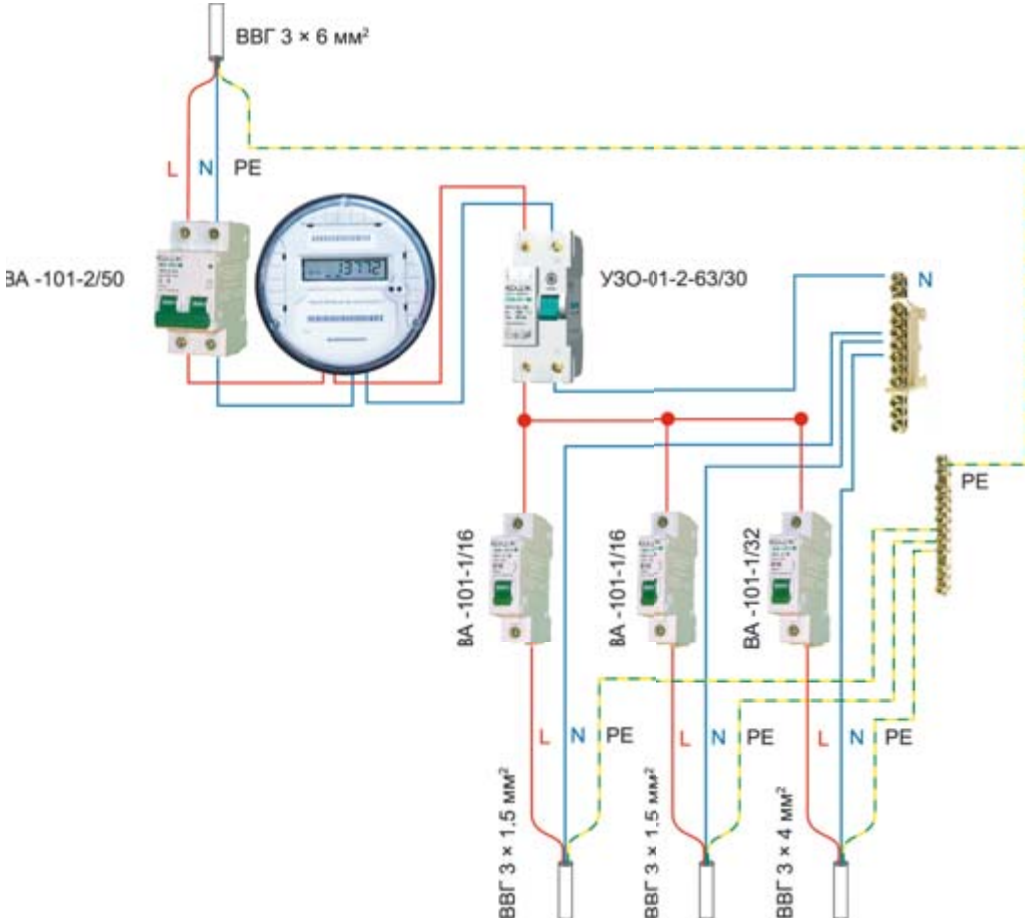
Схема квартирного щитка на однофазную цепь
